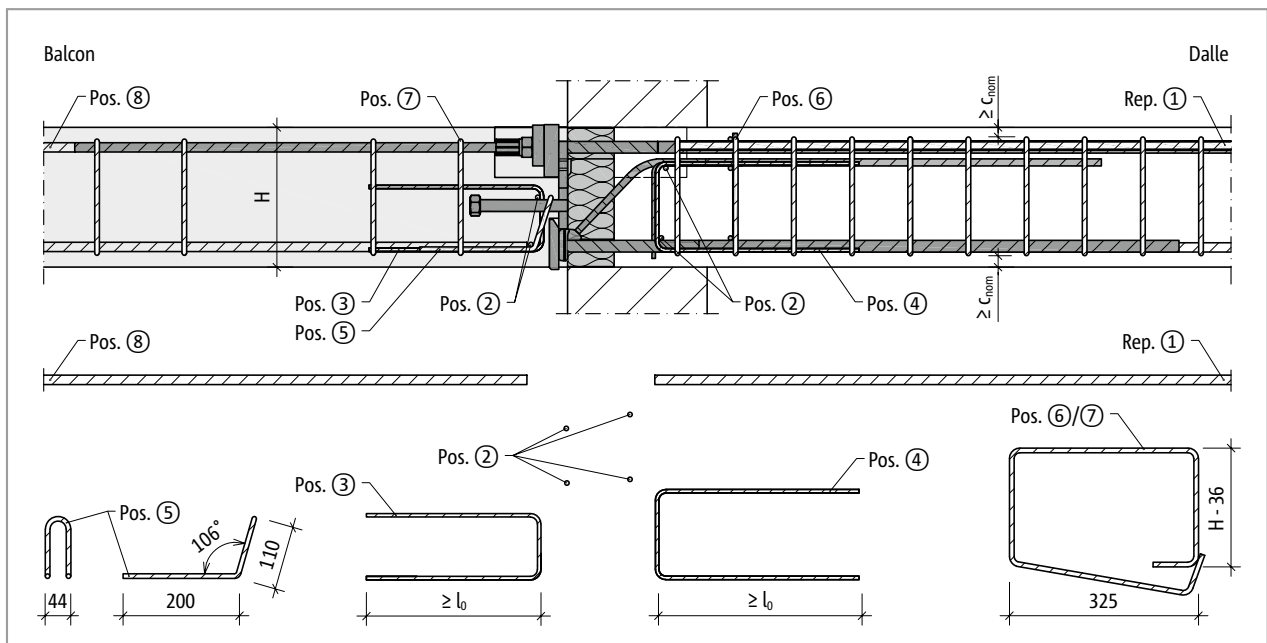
Schöck Isokorb® T type K-IQ-B-CB : armature sur site
